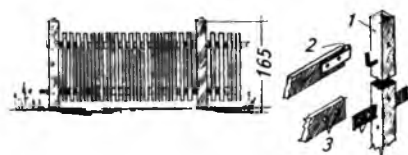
Сборная изгородь с железобетонными столбами: 1 — бетонный столбик; 2 — петля; 3 — отверстие для шурупов
